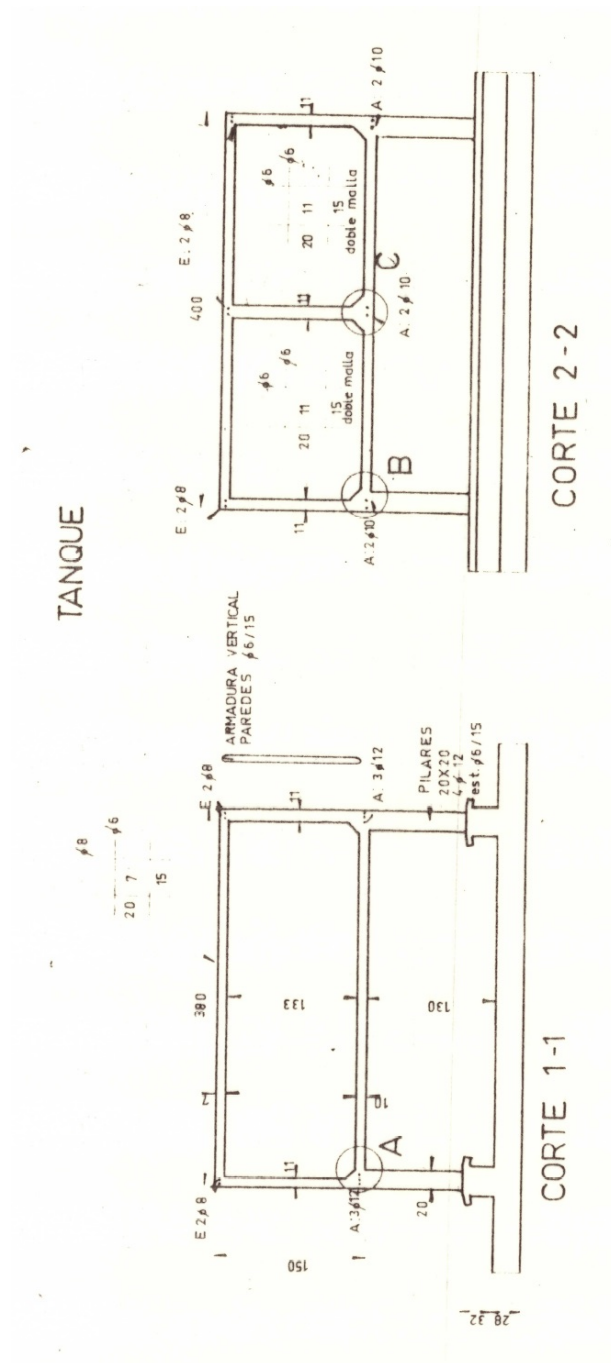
Corte 1-1 y Corte 2-2 de la planta del tanque. (Fuente: Planos de estructura)
